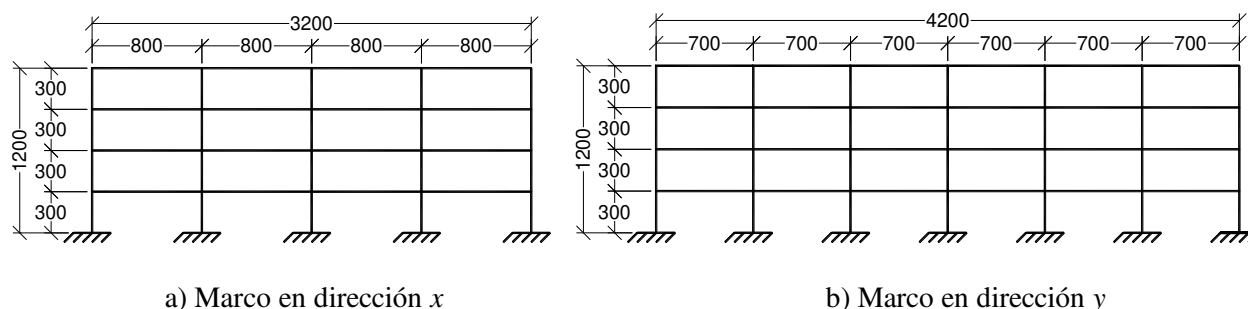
Geometría de edificio, vistas en alzado, unidades: cm
